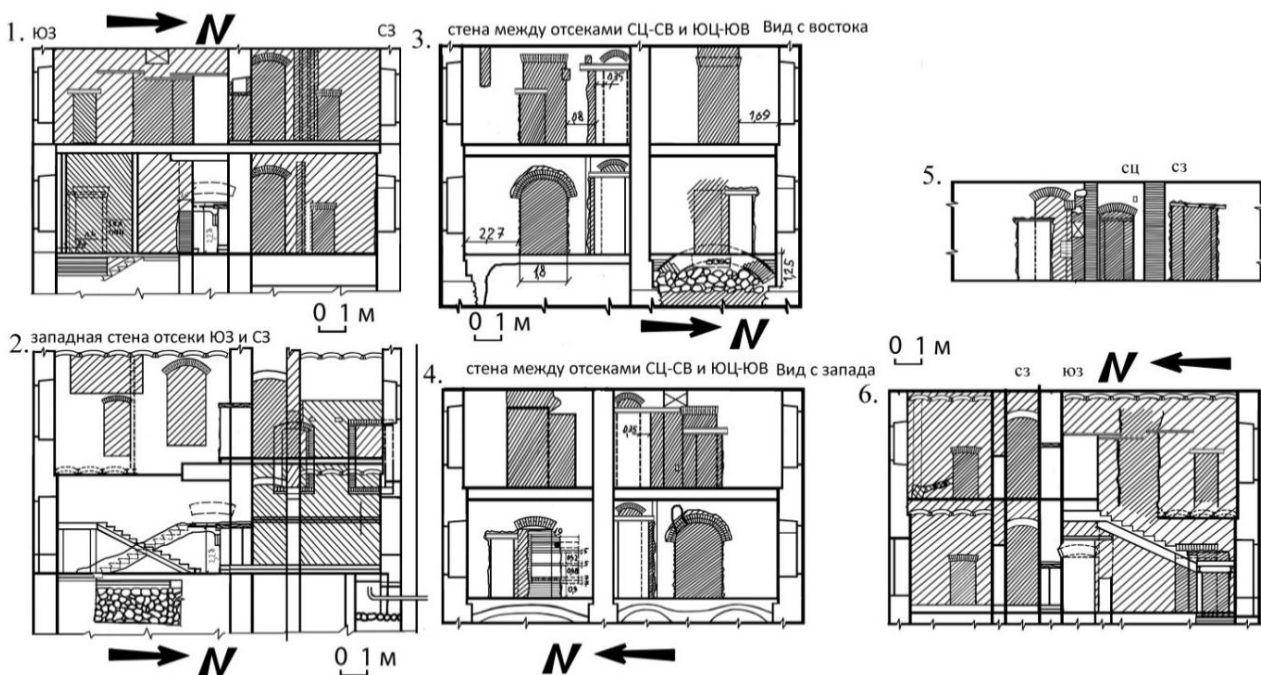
1 и 6. – развёртка поперечных стен в западной части здания; 3 и 4. – развёртка поперечных стен в восточной части здания; 2. – западная стена здания на стыке со «Сталинкой» с фрагментами фасада XVIII в.; участок продольной стены со стороны СЦ отсека на первом этаже
